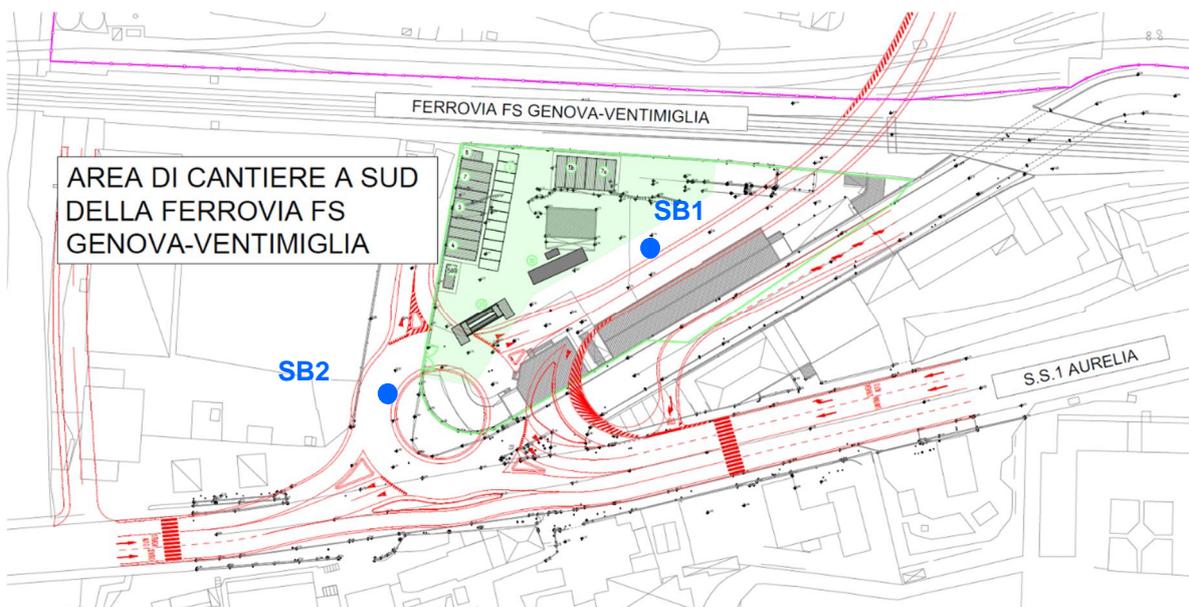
Ubicazione indagini geognostiche eseguite e sovrapposizione sulla planimetria di progetto
